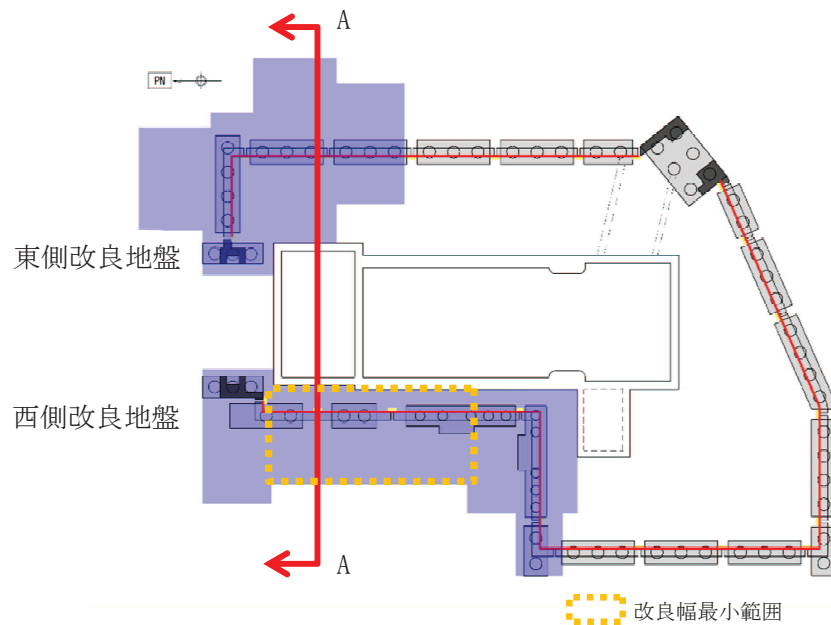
第2号機放水立坑改良地盤評価対象断面 平面図
